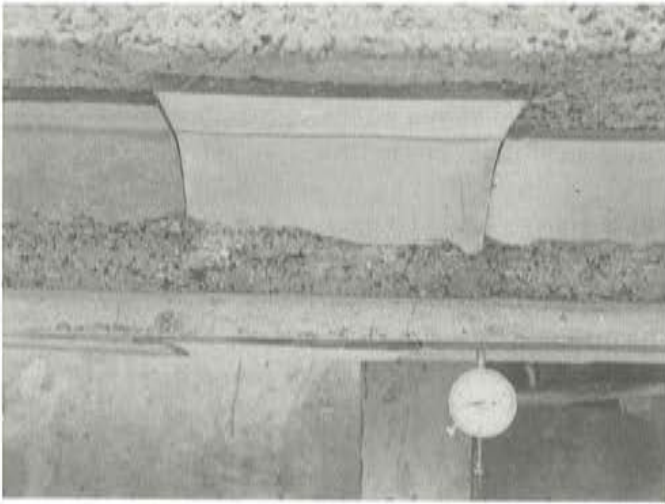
Fisuración de un elemento de la serie B-2.
